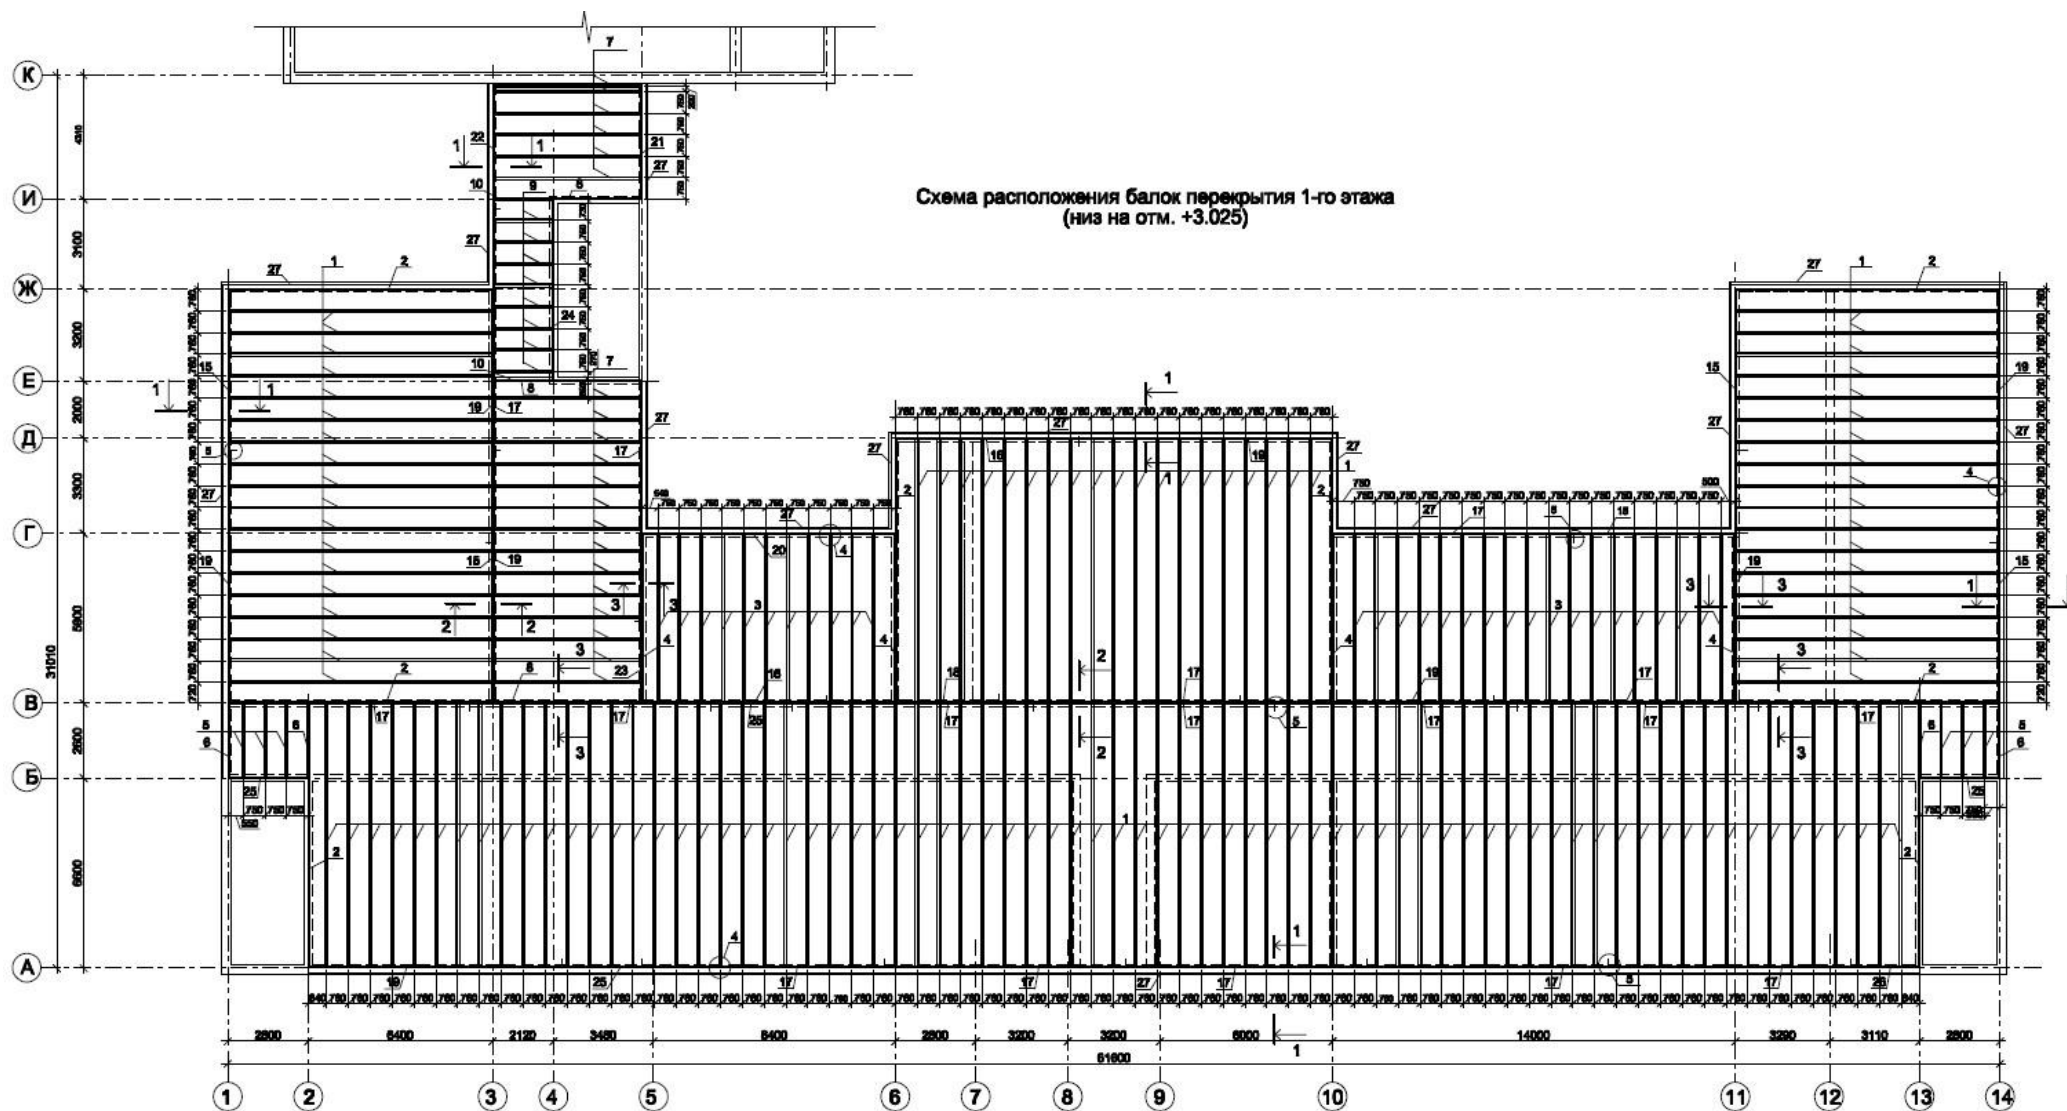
План раскладки балок перекрытия над первым этажом
